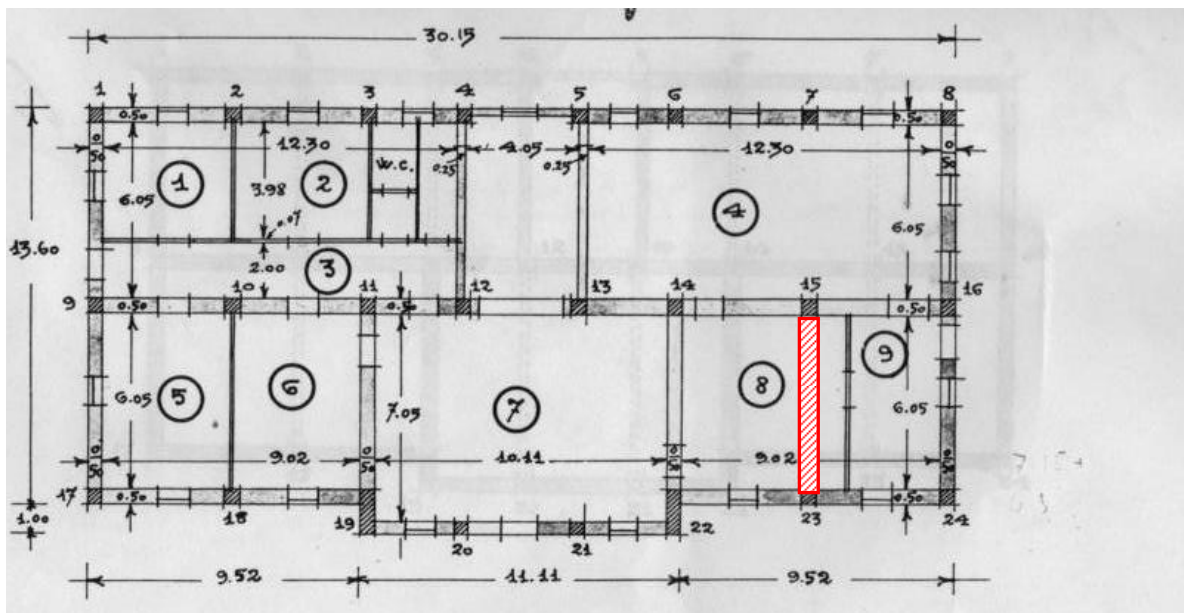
Progetto originale del piano seminterrato dell'Edificio Comunale con evidenziato in rosso la posizione del muro di controvento aggiunto.
